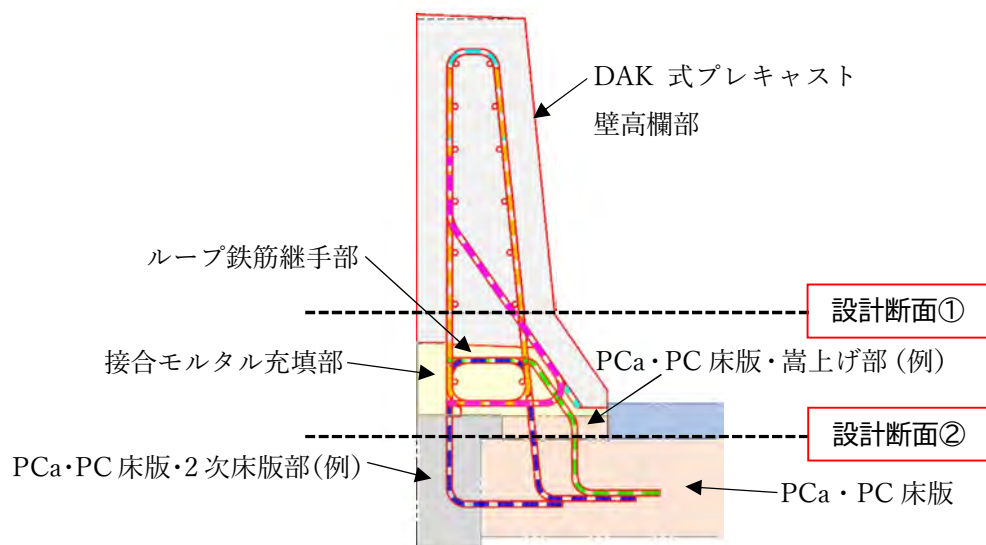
DAK 式壁高欄の鉄筋配置及び部材の設計断面位置
